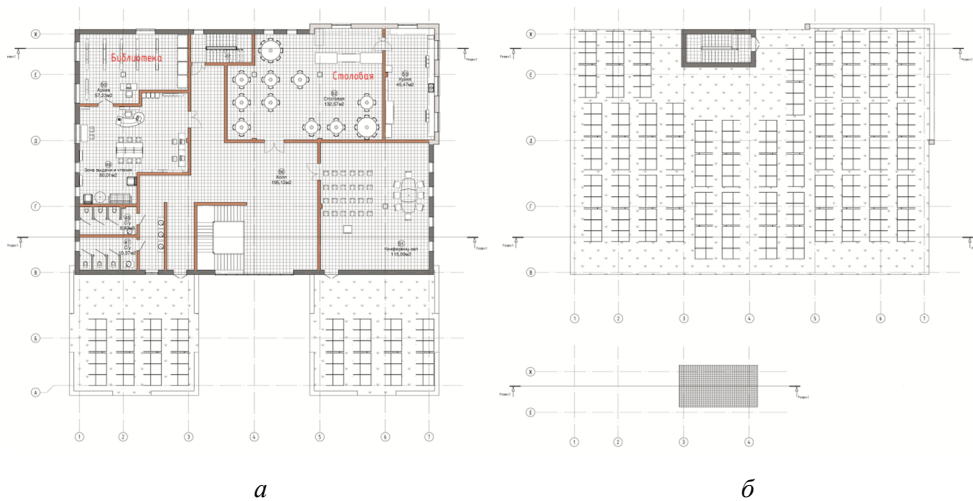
Планы третьего этажа (а) и кровли (б) здания
